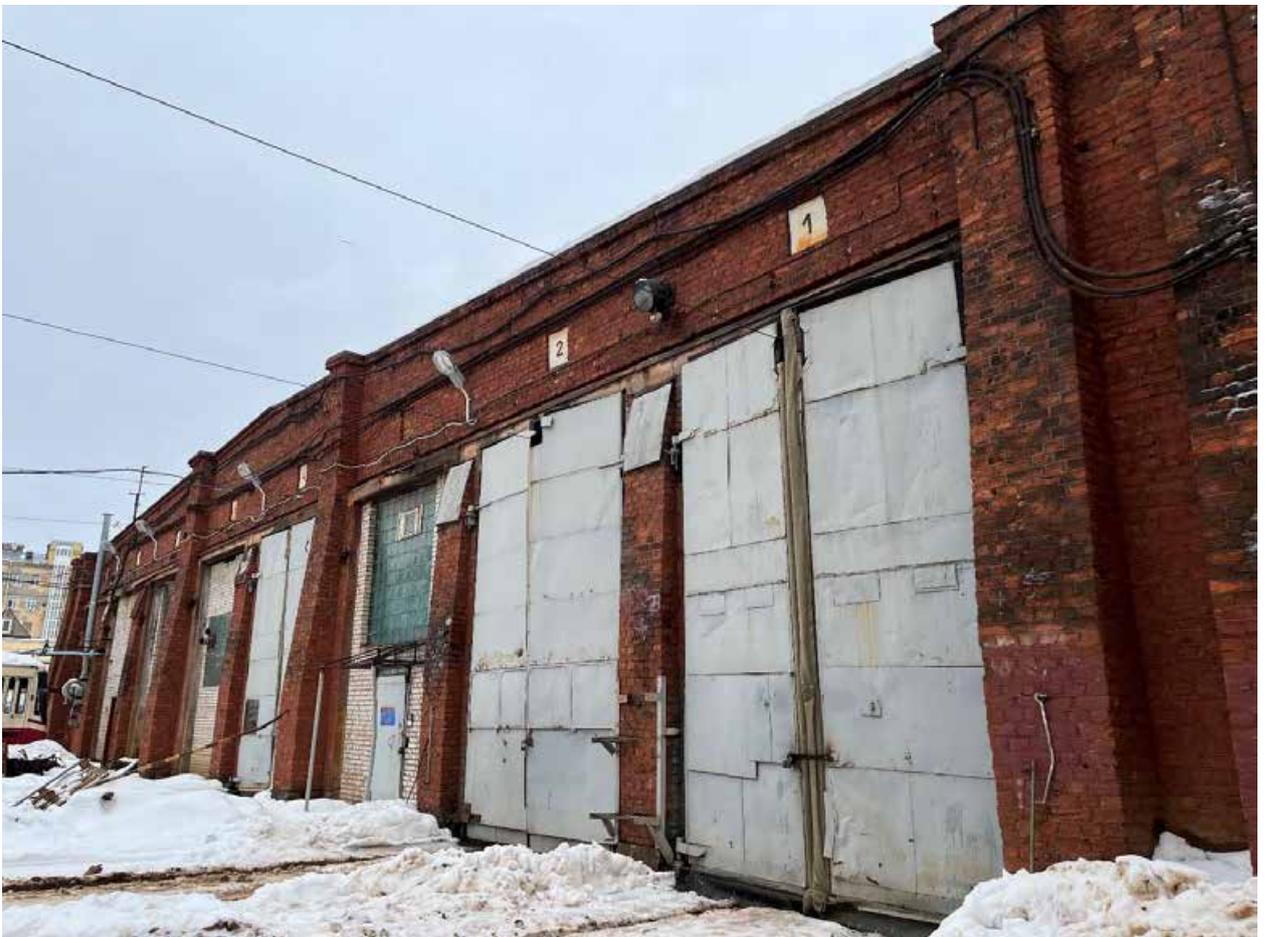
Здание депо под лит. П. Угол северного и западного фасада.
